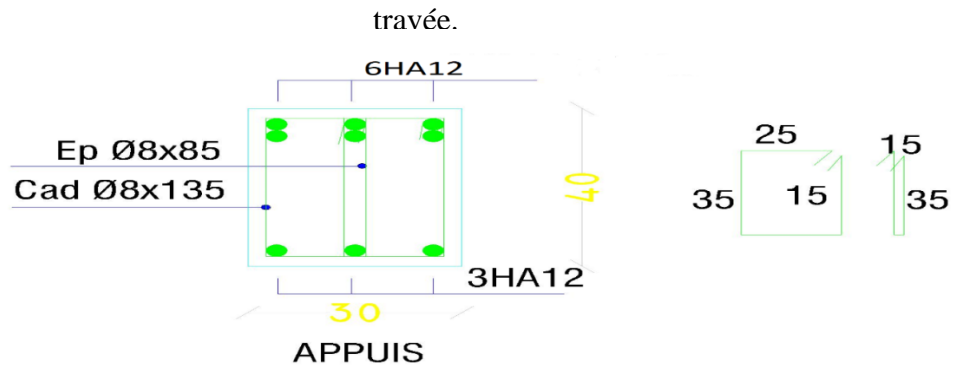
Ferraillage poutre secondaire au niveau terrasse et étage courant, sur appui
